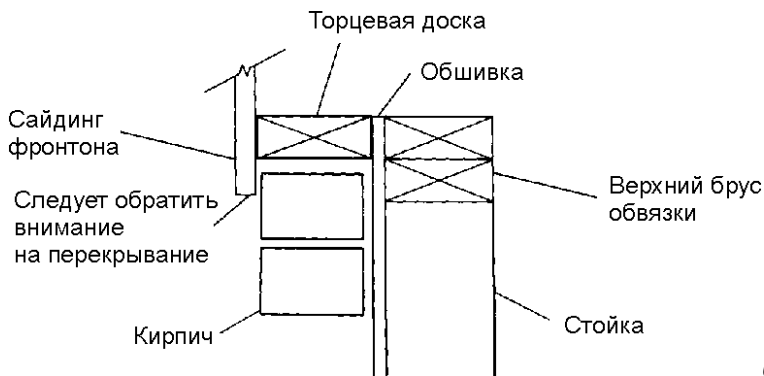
Создание рамной конструкции фронтового свеса:
